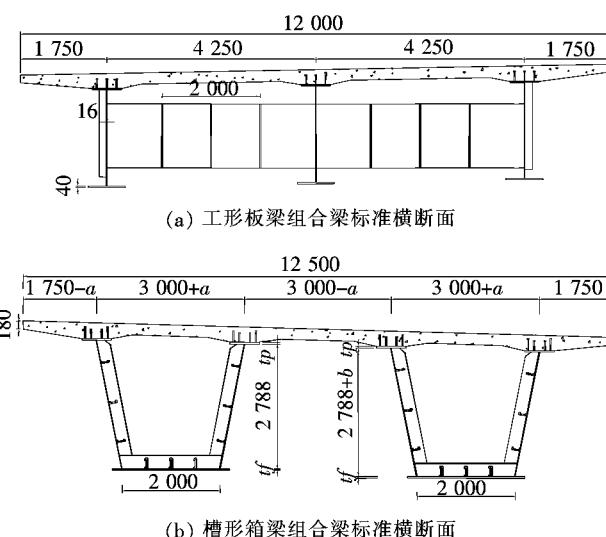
钢—混凝土组合梁典型设计断面(单位:cm)
